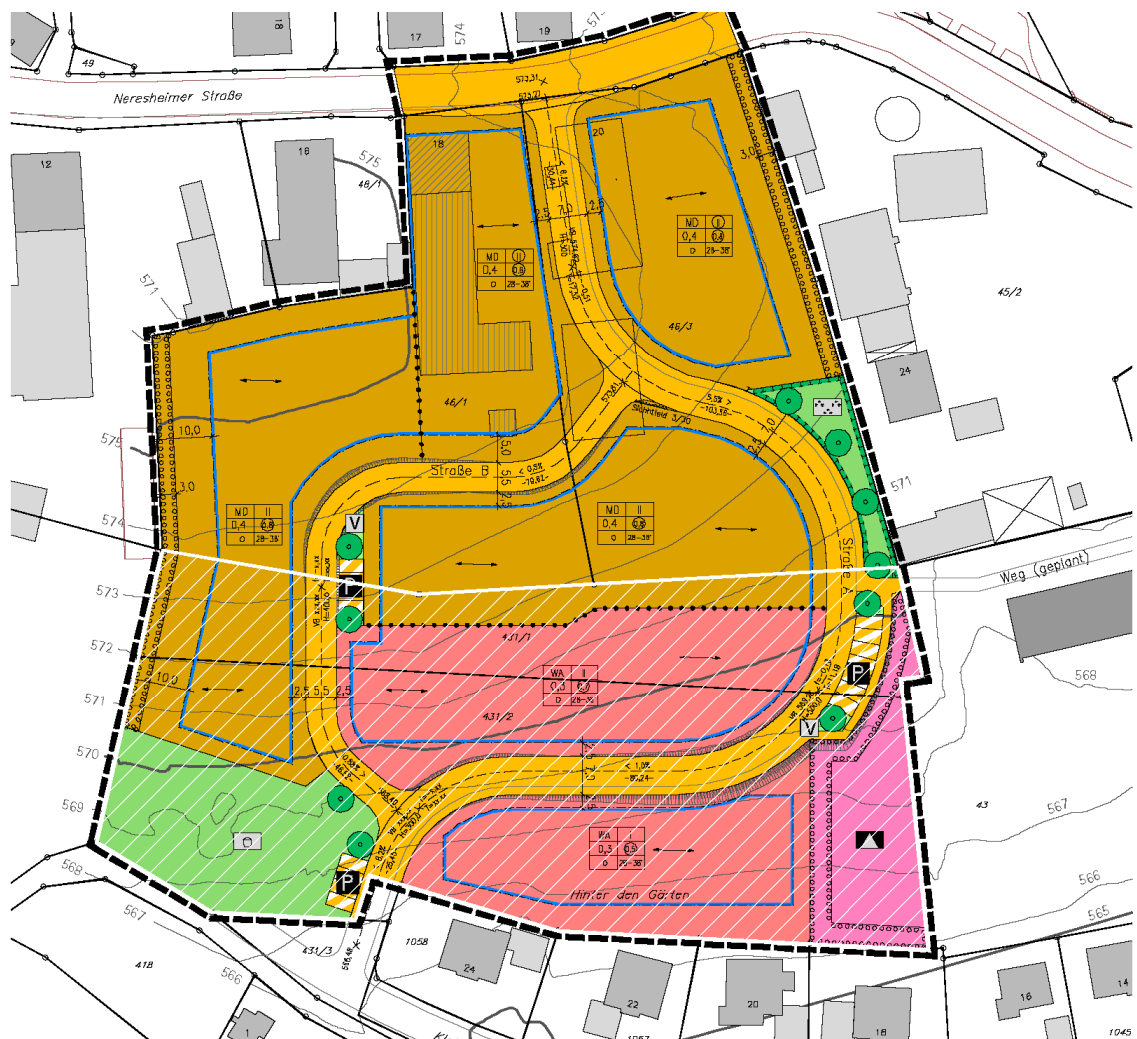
Plangebiet des Bebauungsplans für den Umweltbericht (Schraffur)
